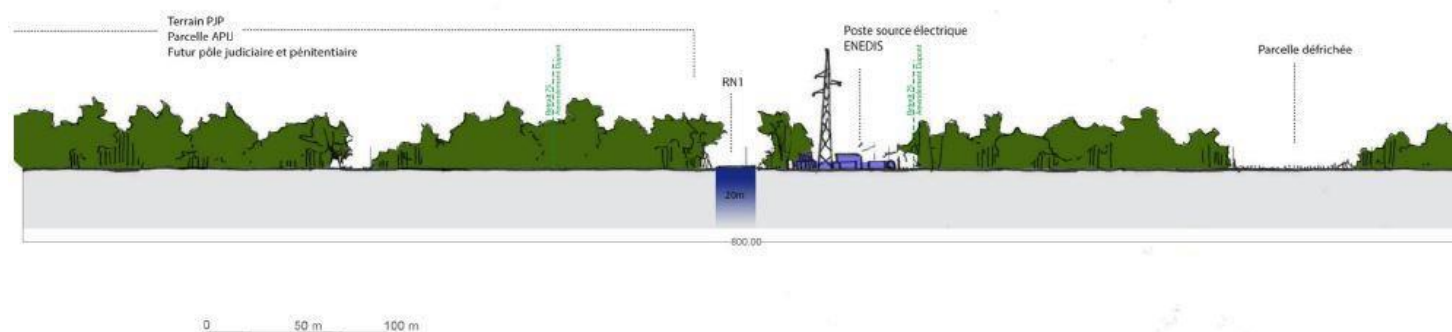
Coupe paysagère sur la RN1 au droit du site (*avant défrichement*). Source : SEURA, 2019. Plan Guide d'aménagement, périmètre OIN Margot
